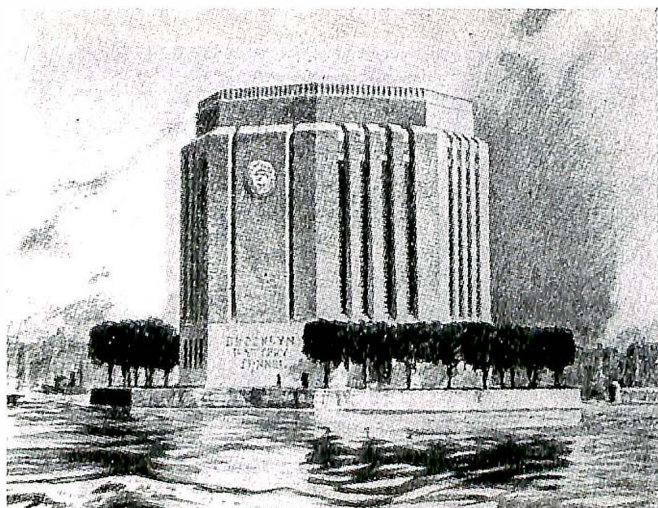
Ventilasjons- og elevatortårn i tunnelen.
